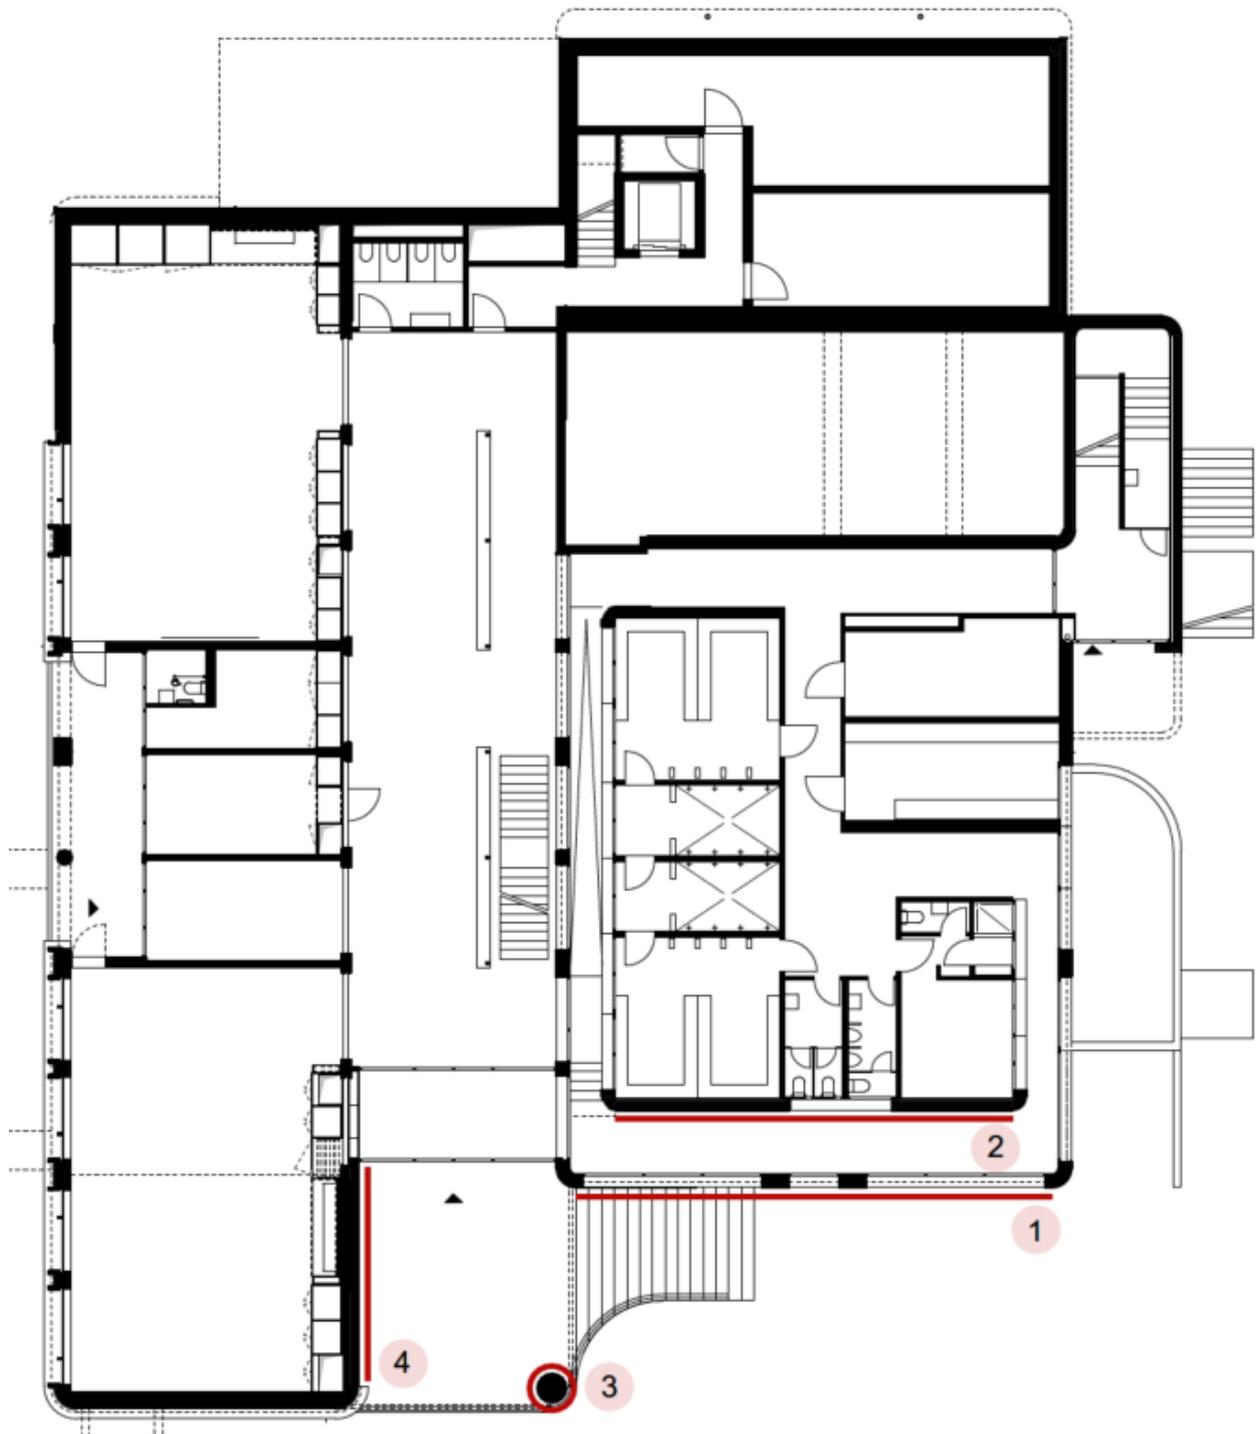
Standortübersicht für Kunst und Bau, Grundriss Erdgeschoss
